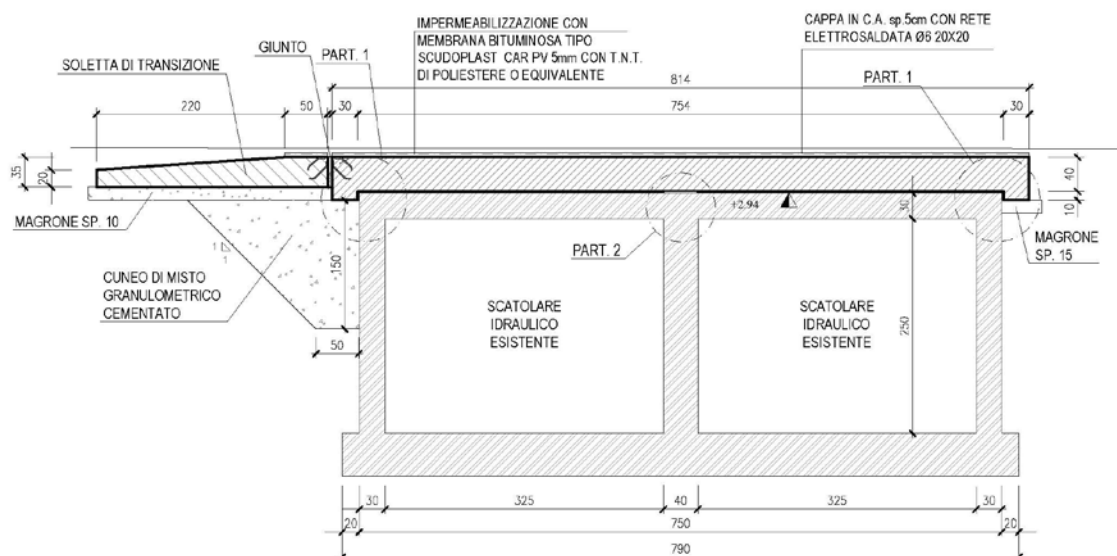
Sezione trasversale soletta di rinforzo collettore
